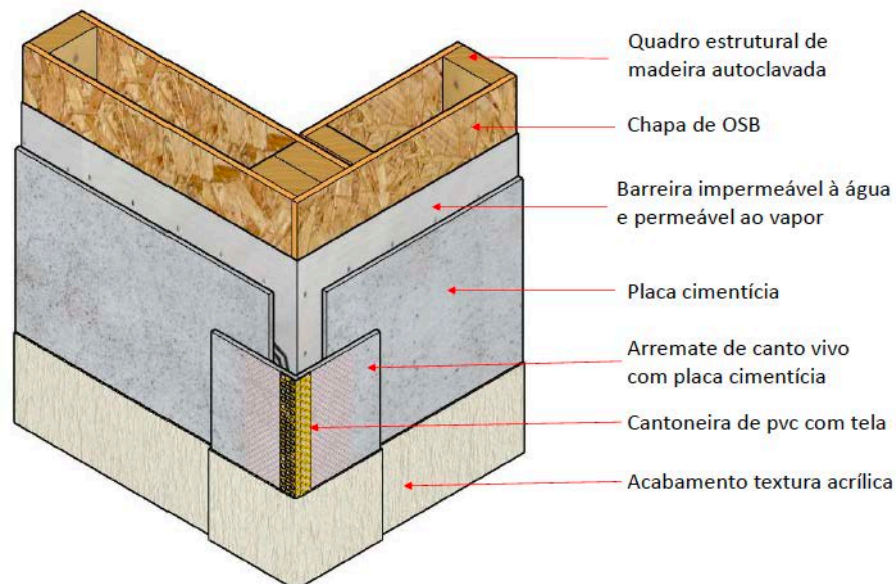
Ilustração da cantoneira de PVC aplicada sobre o arremate de canto vivo em placa cimentícia.
